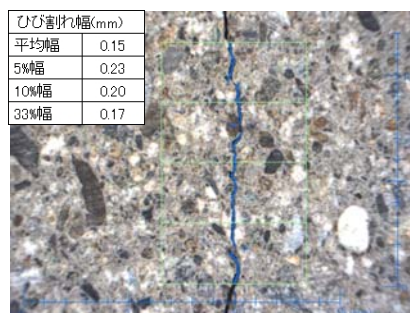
検出されたひび割れの例(幅0.15mm)
